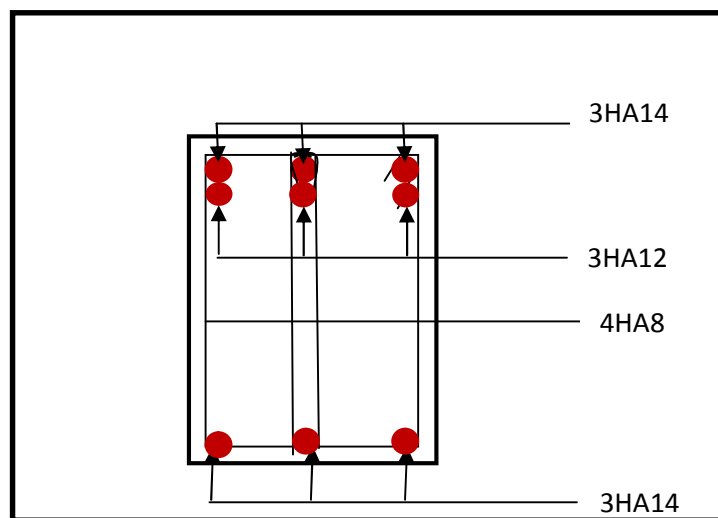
Ferrailage aux appuis d'une poutre secondaire.
